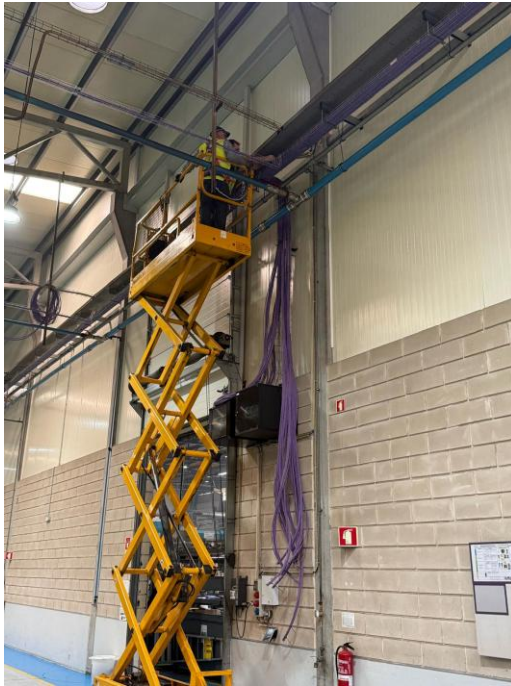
Instalação de esteiras armadas e ligação de cabos ao servidor
